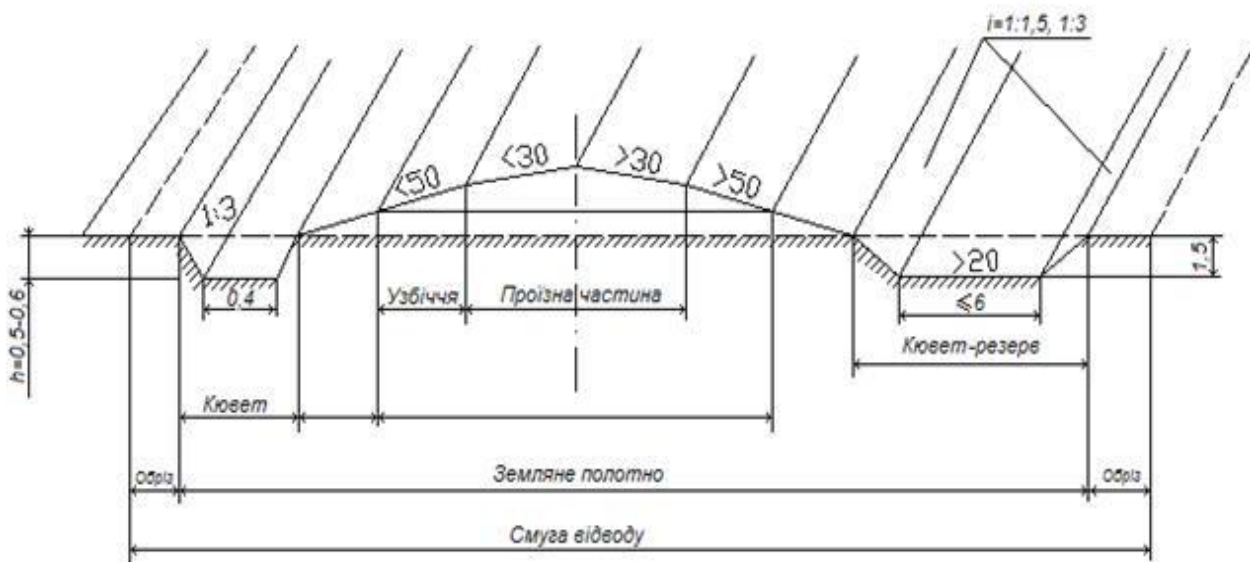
Поперечний переріз та будова дорожнього полотна
